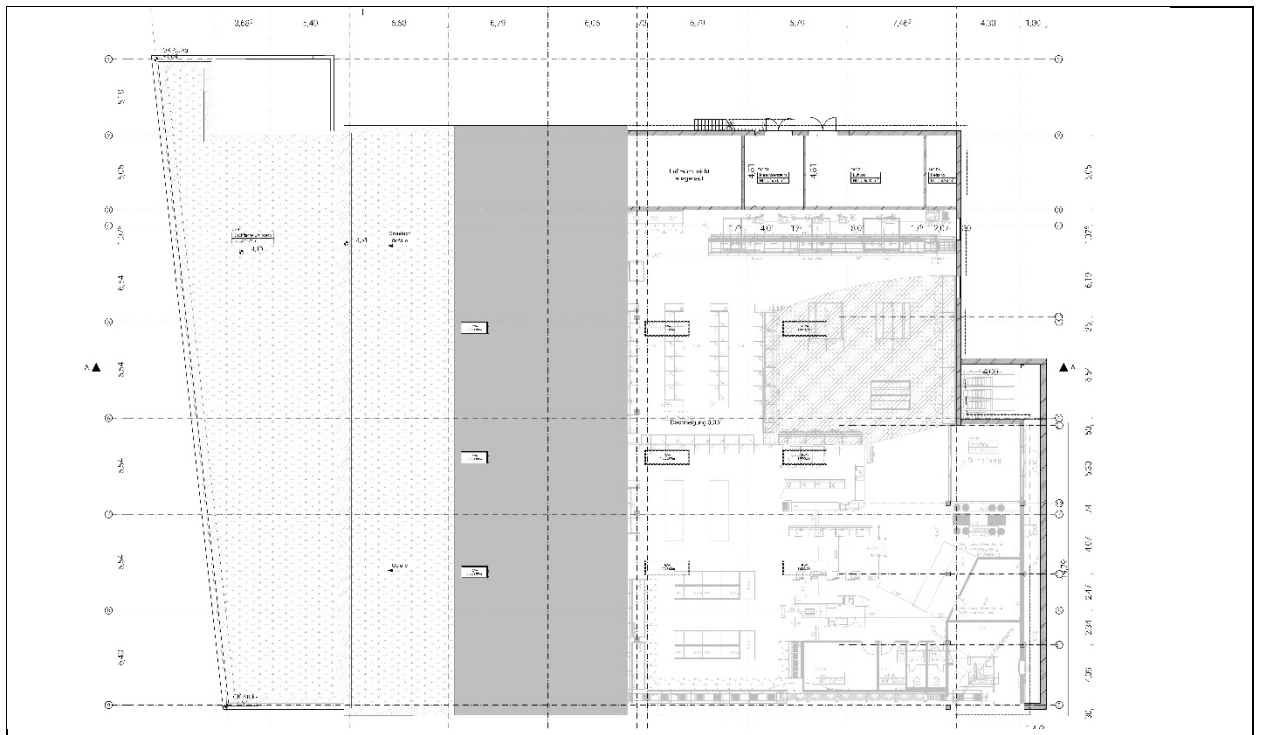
Grundriss Obergeschoss mit Veränderungen gegenüber der aktuellen Situation
